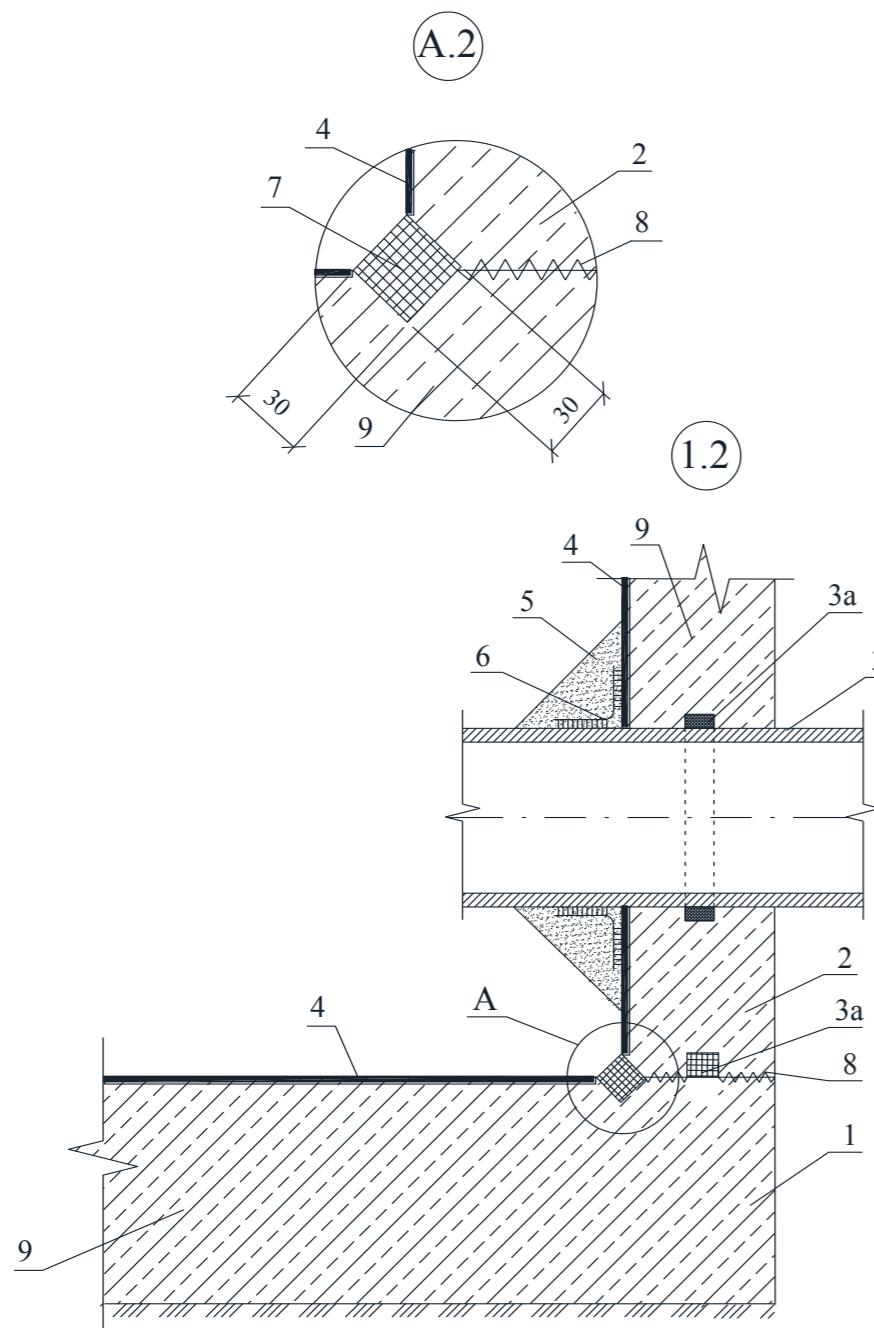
Узел 1.2 Сопряжение гидроизоляции фундаментной плиты и стены бассейна
